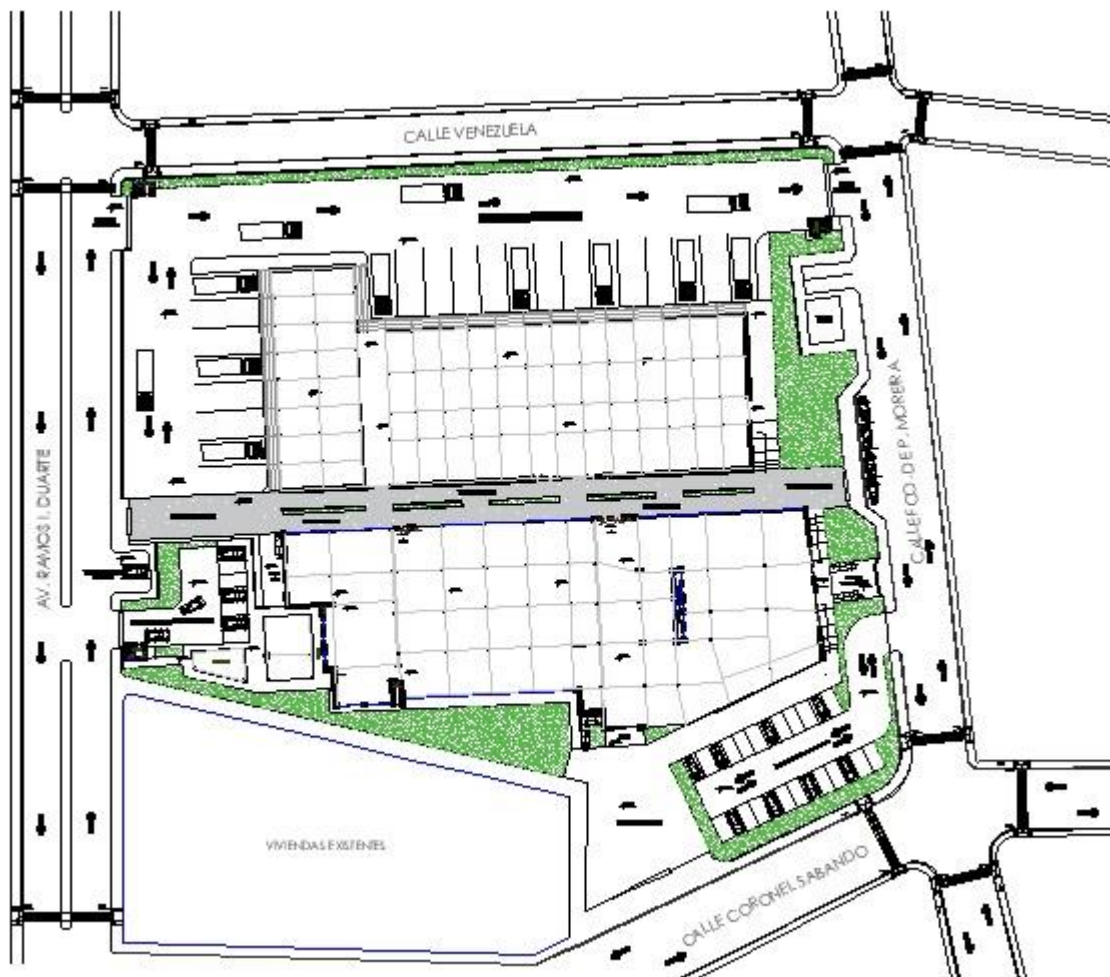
, Planta Estructural de la nueva propuesta del Mercado N° 2 de Portoviejo.
